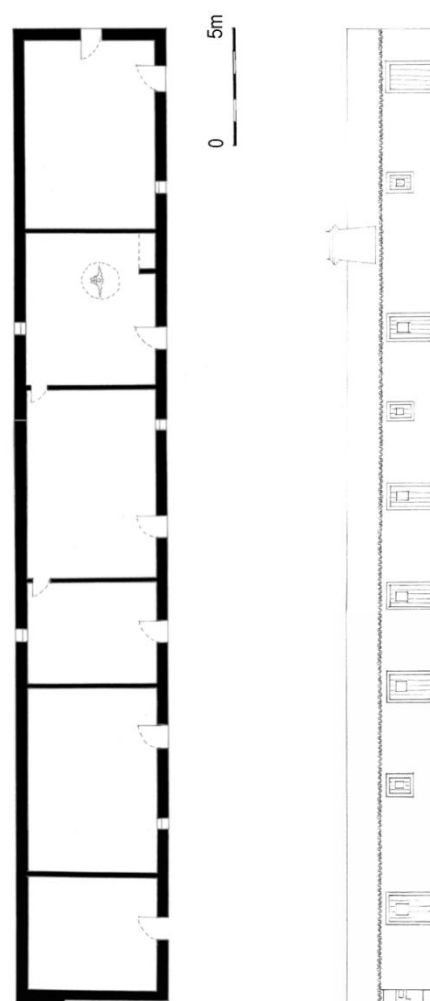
Planta e alçado frontal, da habitação principal do complexo de taipa/xisto em São Domingos. (nº 1 da imagem 17). Ficha nº 31 do volume II: Anexos
